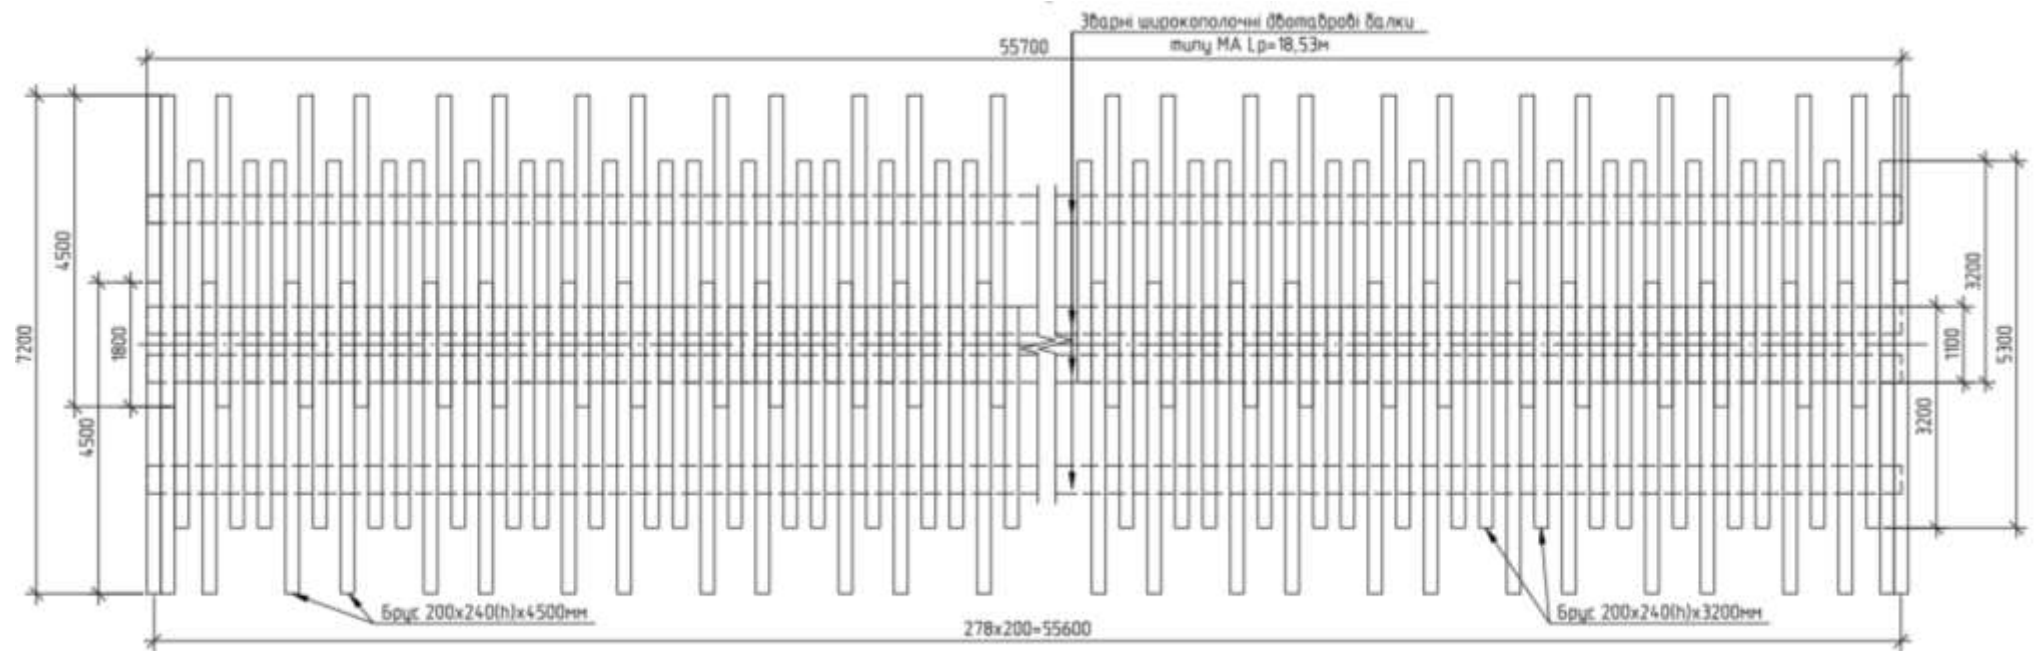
Монтажна схема розкладки поперечних брусів дорожнього настилу по металевим балкам прогонових будов.
